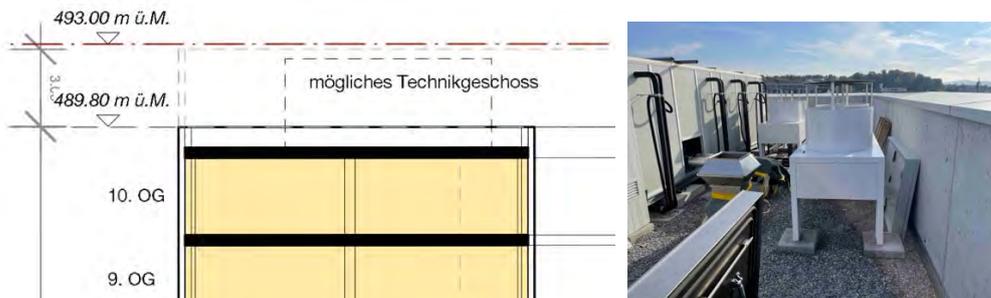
Schnitt und Referenzbild integriertes Technikgeschoss Ankerbau (Galli Rudolf Architekten)
